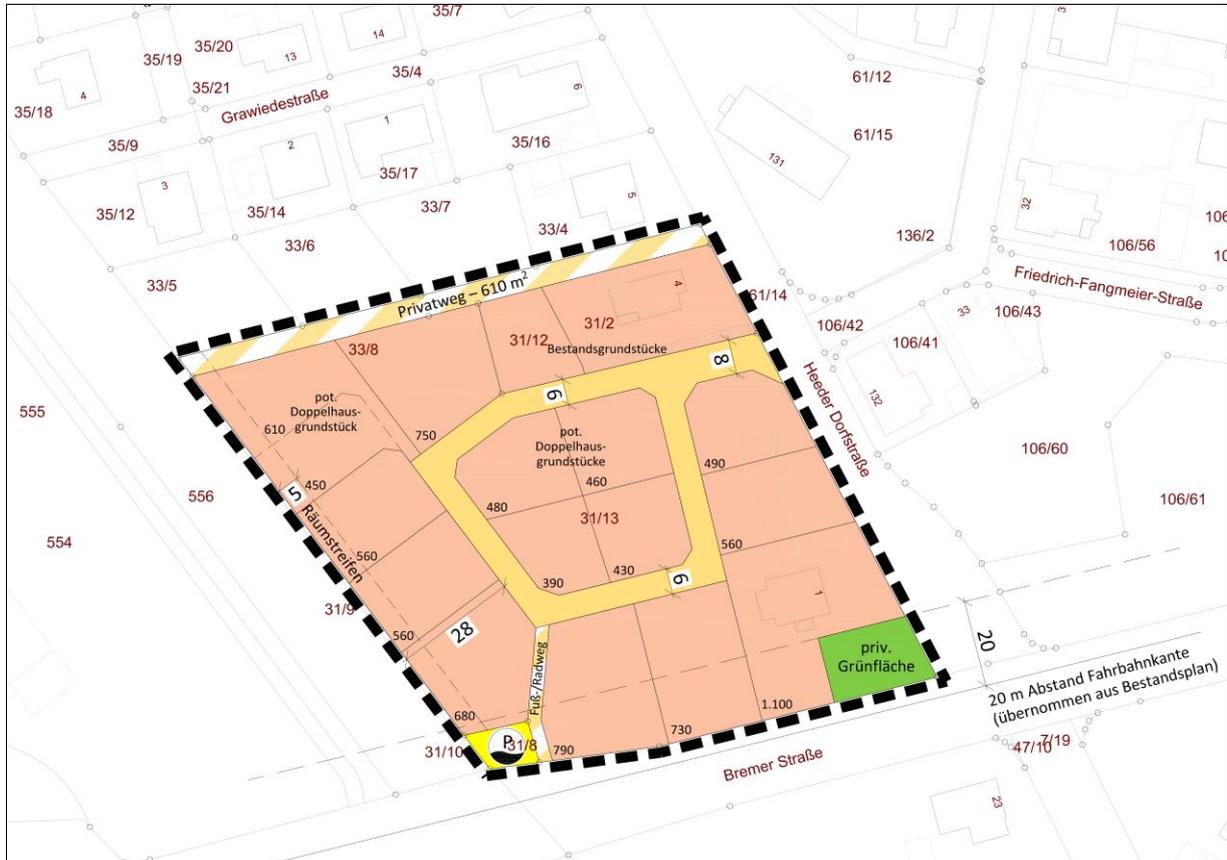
Darstellung Entwurf Bebauungsplan Nr. 5, 1. Änderung
